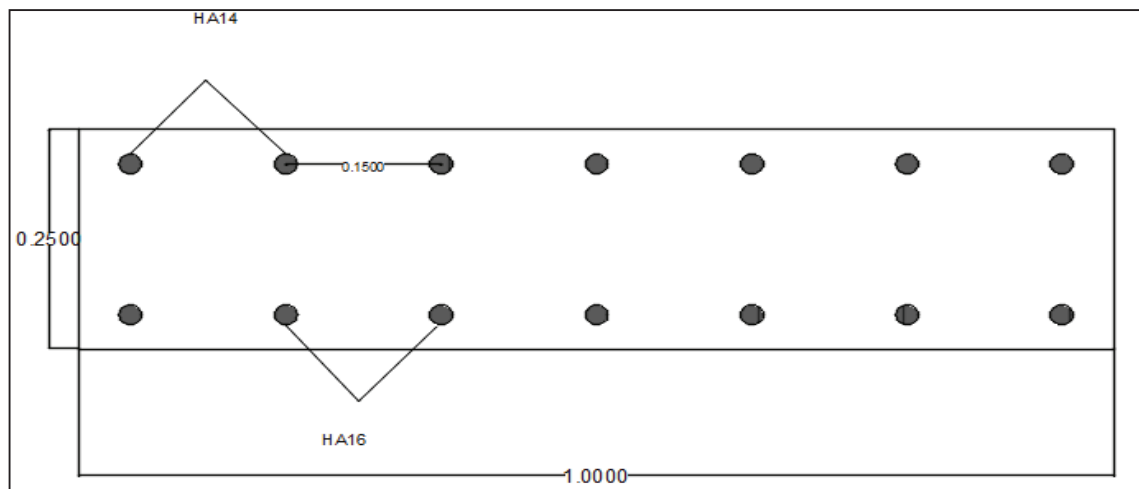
Schéma de ferrailage transversale de la dalle.
